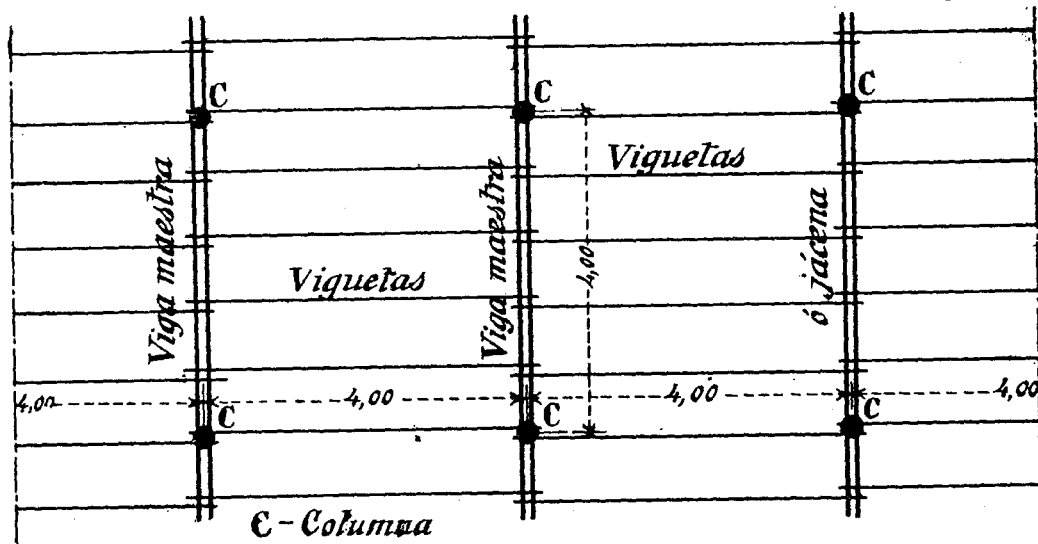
Entramado del techo de un almacén (columnas, vigas maestras y viguetas).
